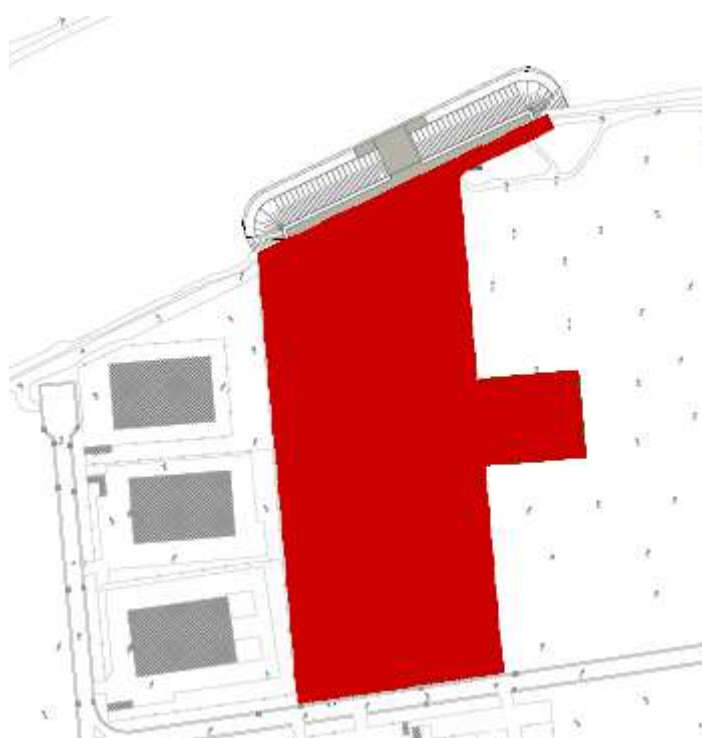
Fase 5 completamento e sistemazione superficiale area impianto
